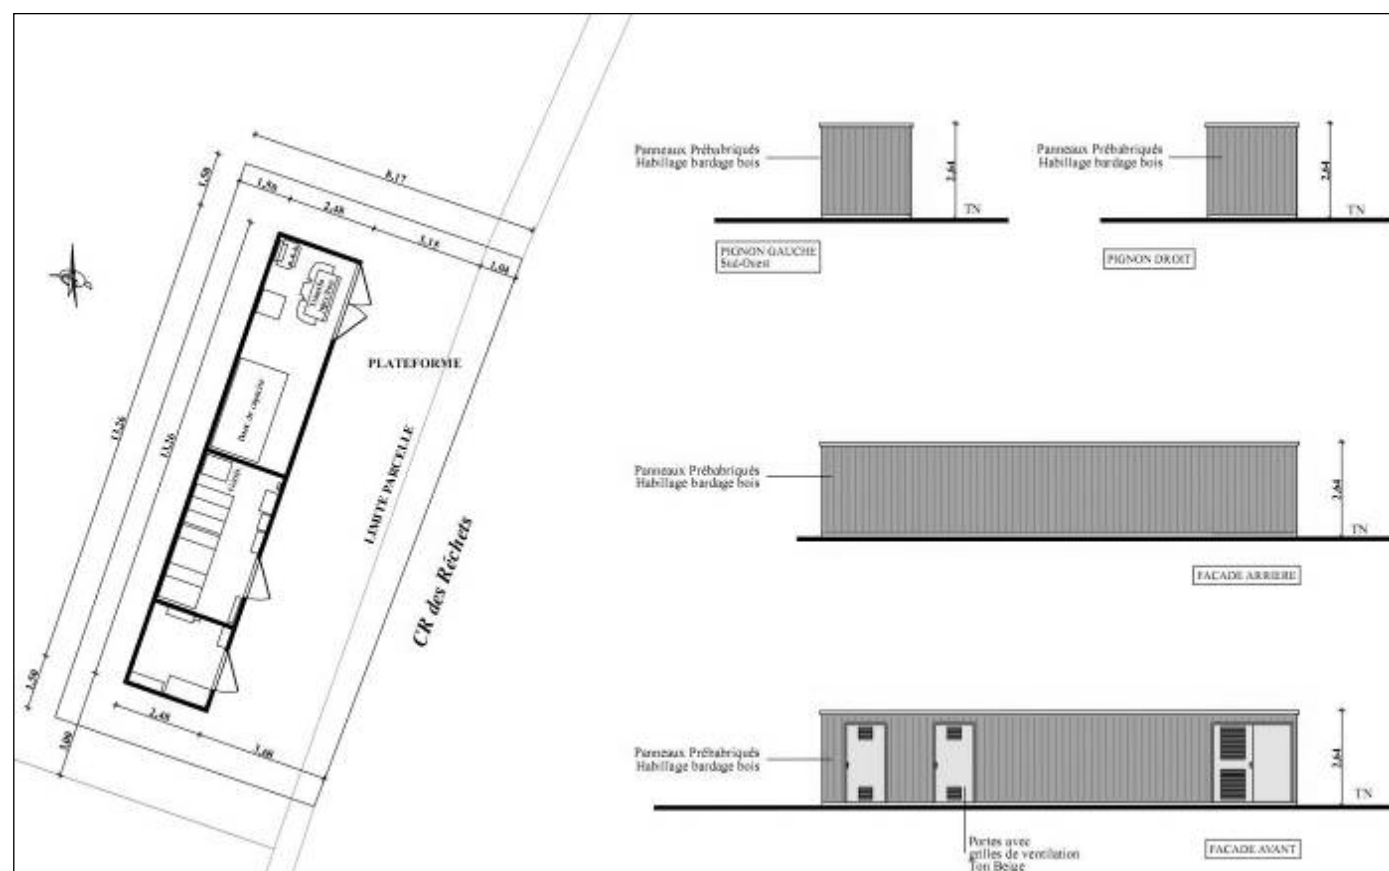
plans des façades et des toitures du poste de livraison du projet des Charbonnières
